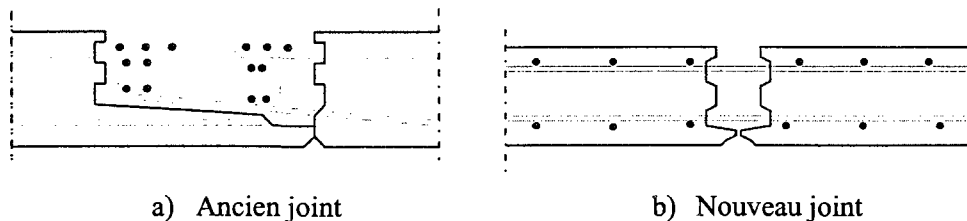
Joints entre les pré-dalles préfabriquées (Harryson et Gylltoft 2001)
